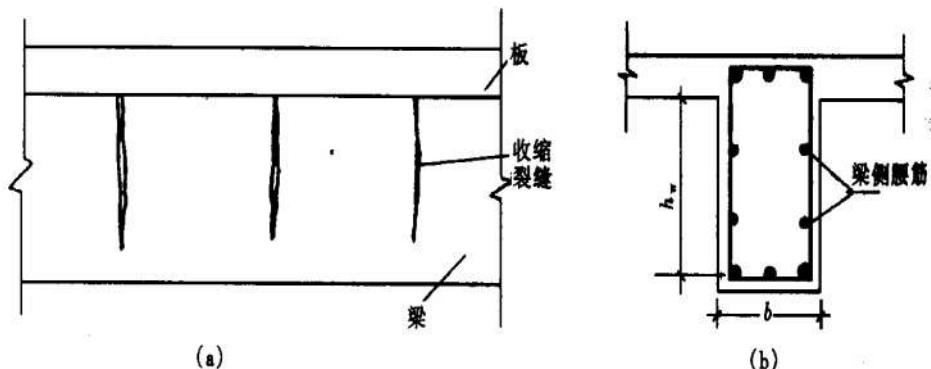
梁侧防裂的纵向构造钢筋
